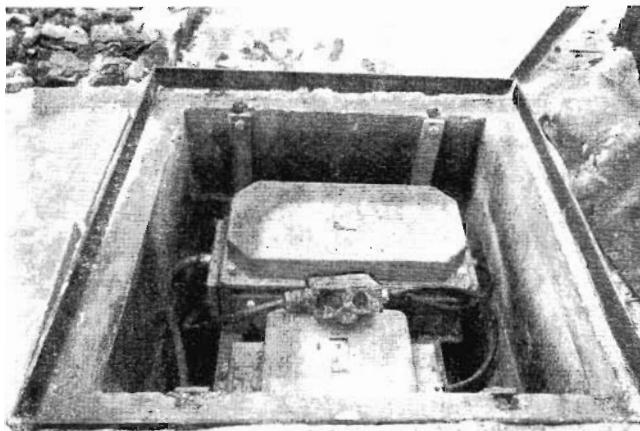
Geöffneter Schacht mit Klemmenkasten und Isolierumspanner für Stabheizung
